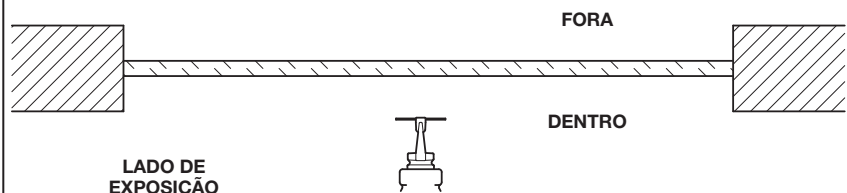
A-2 -- SEPARAÇÃO DE INCÊNDIO EXTERNA - SPRINKLERS NO INTERIOR
